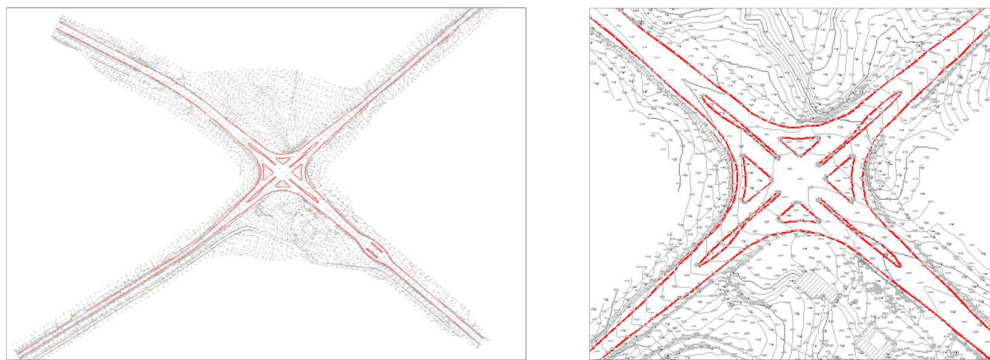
Levantamento topográfico e vista próxima da geometria do cruzamento
